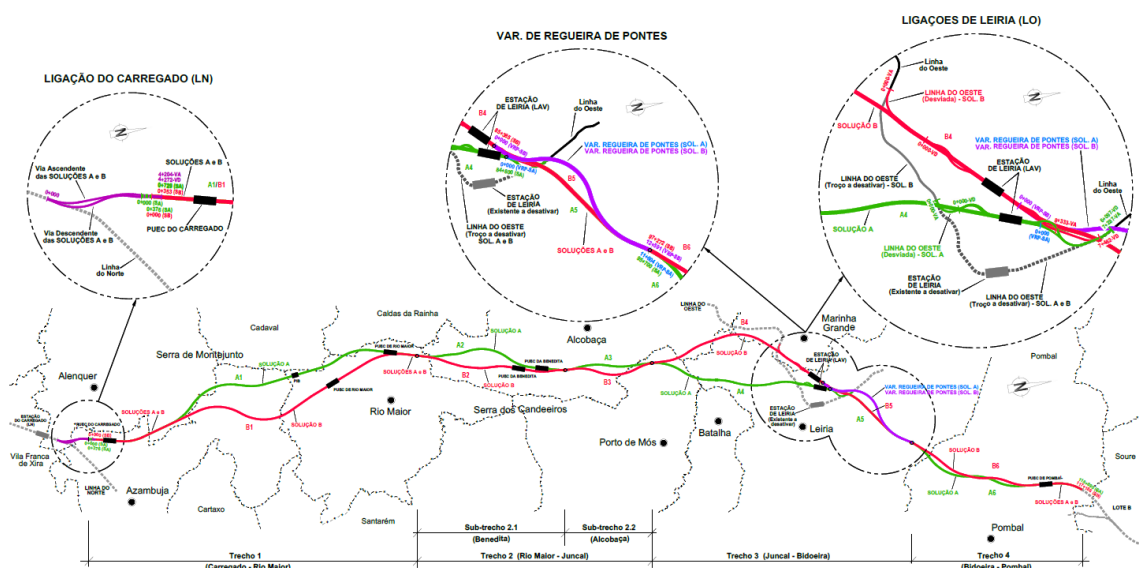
Esquema das alternativas de traçado do Lote C (Infraestruturas de Portugal SA, 2024).
